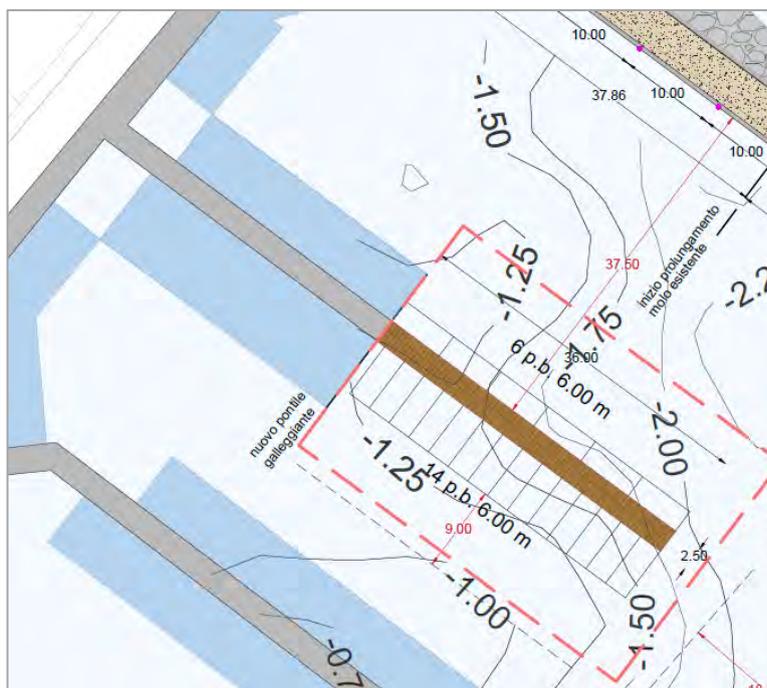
Stralcio planimetrico prolungamento pontile galleggiante
